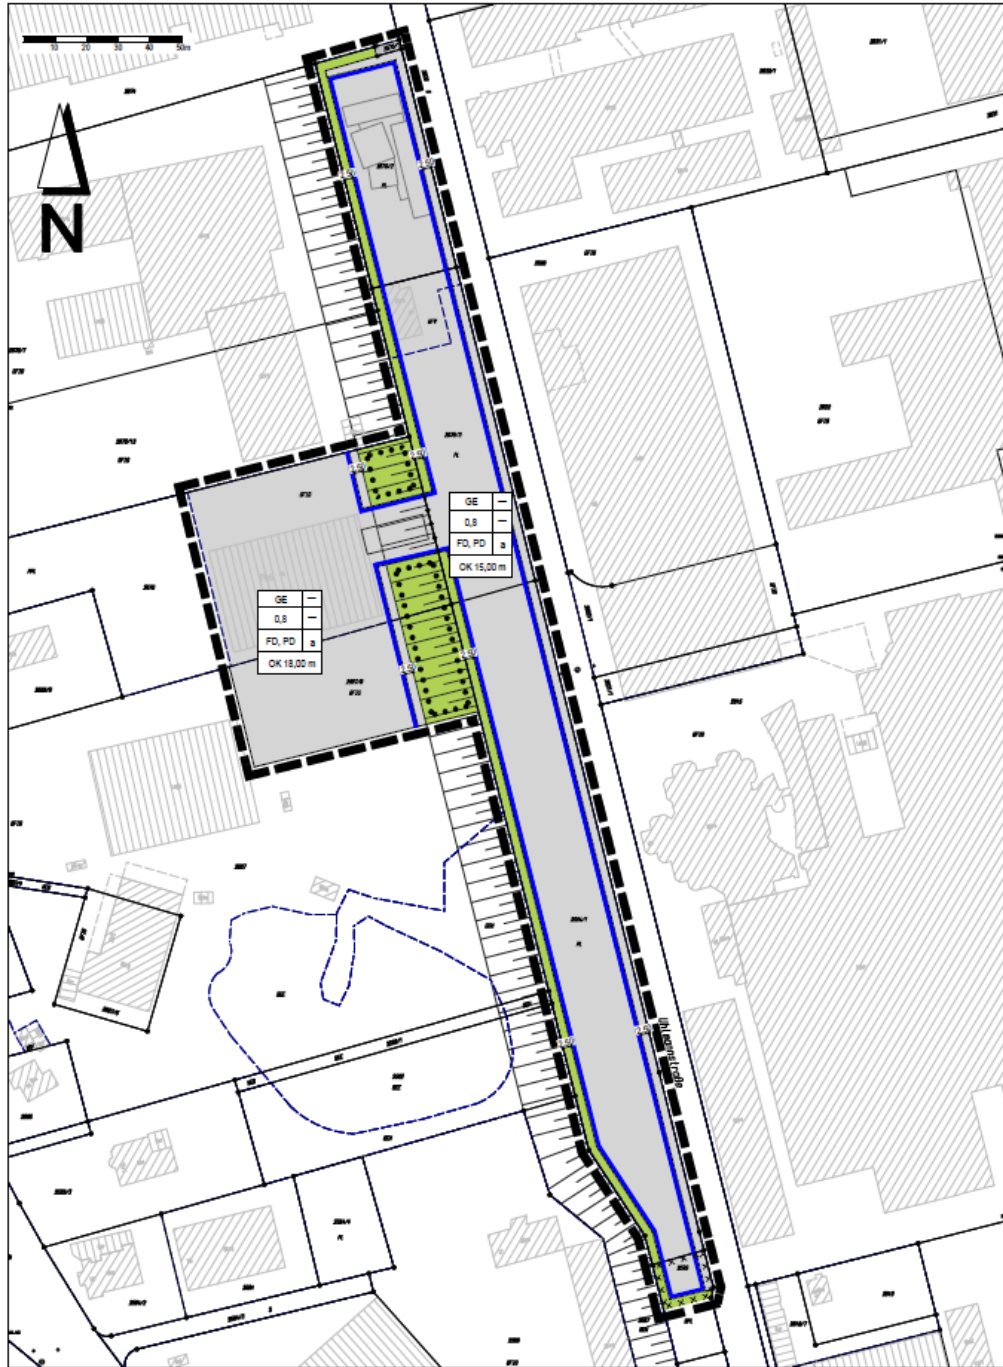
Lageplan Geltungsbereich (Stadt Laupheim, 2024)
